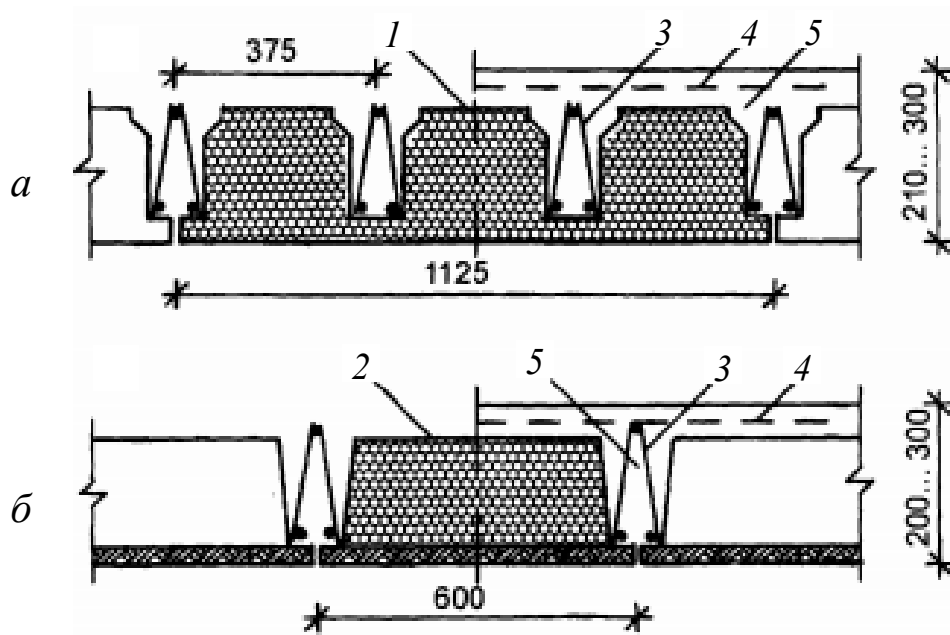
Теплоизолированные монолитные железобетонные ребристые перекрытия:
